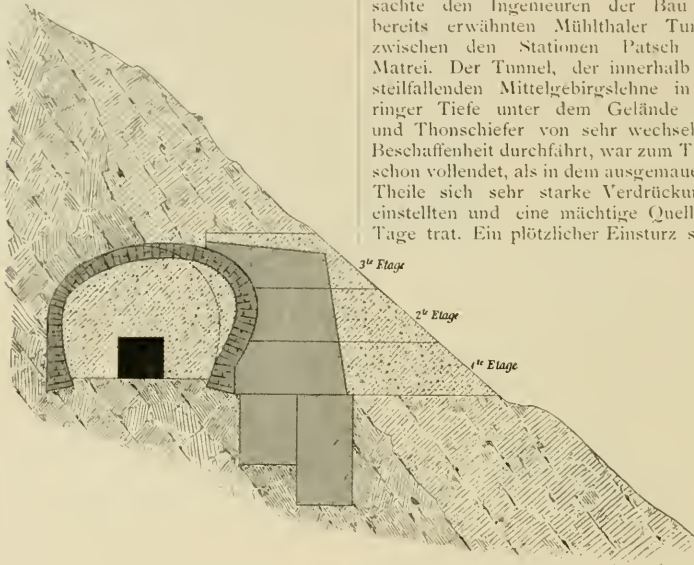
Reconstruction des Mühlthaler Tunnels. [Brennerbahn.]
